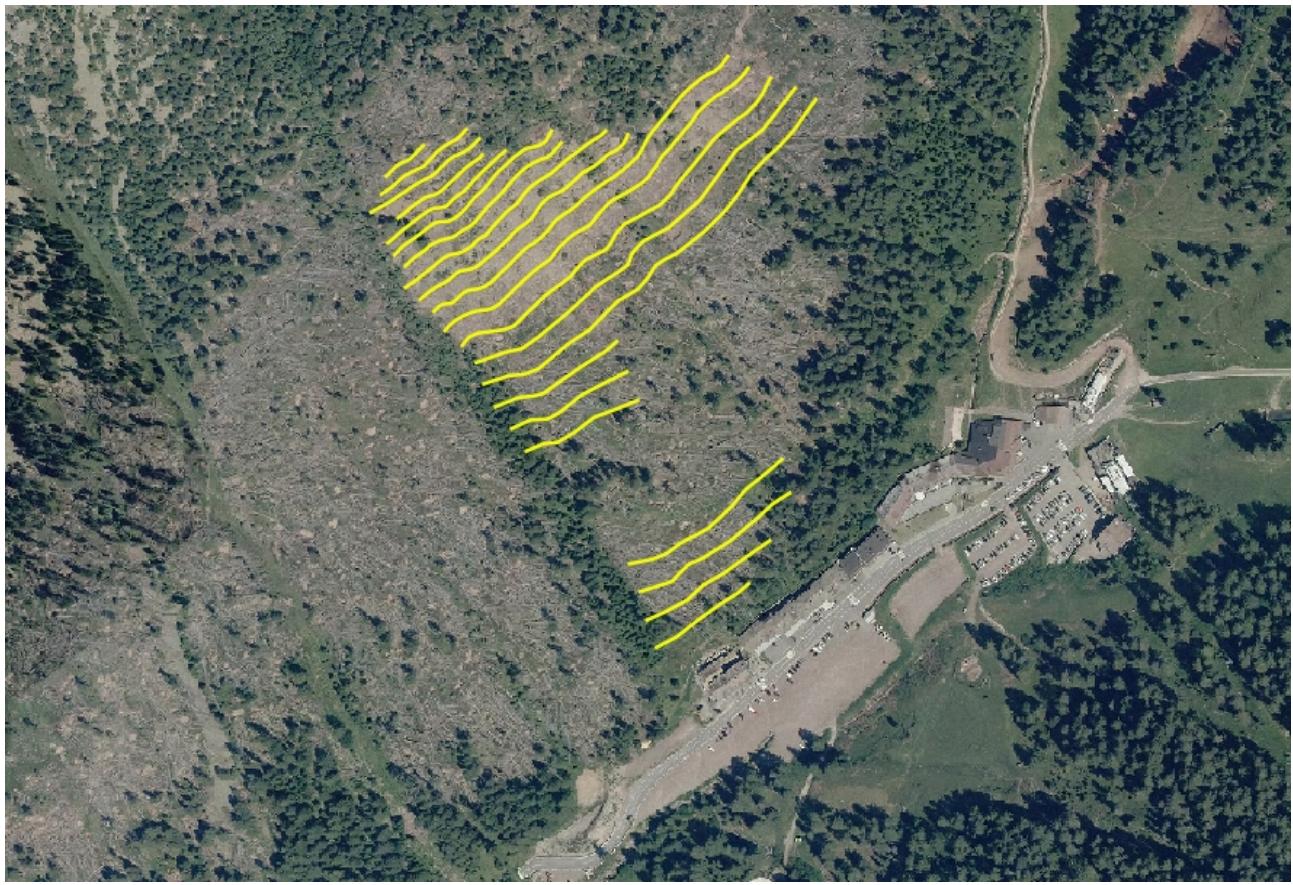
e 3. Planimetria e foto panoramica delle opere di protezione recentemente ultimate (zona 3).
